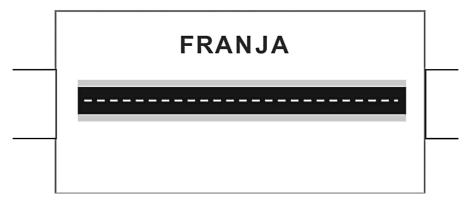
Franja de pista Fuente: Anexo 14
